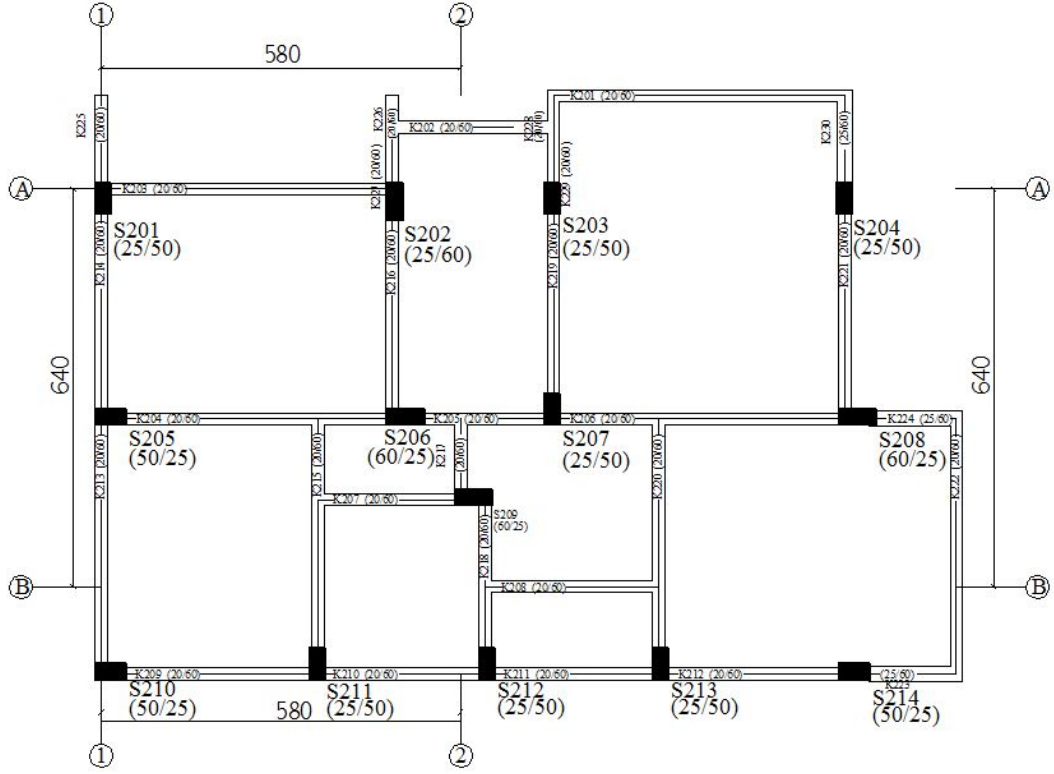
3K-B2 nolu binanın kalıp planı
